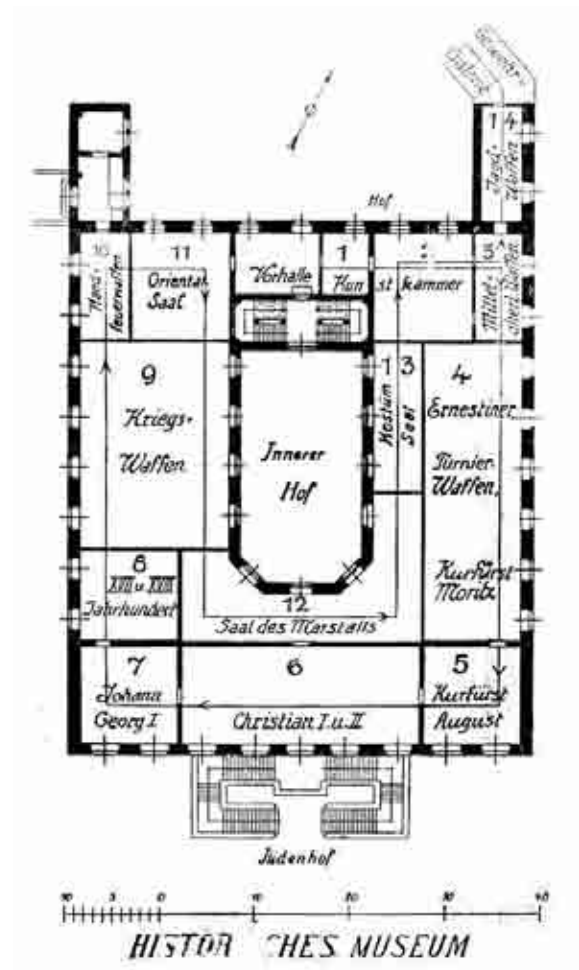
(#143) Grundriss des Historischen Museums, Dresden, 1900. (Foto: TW)
